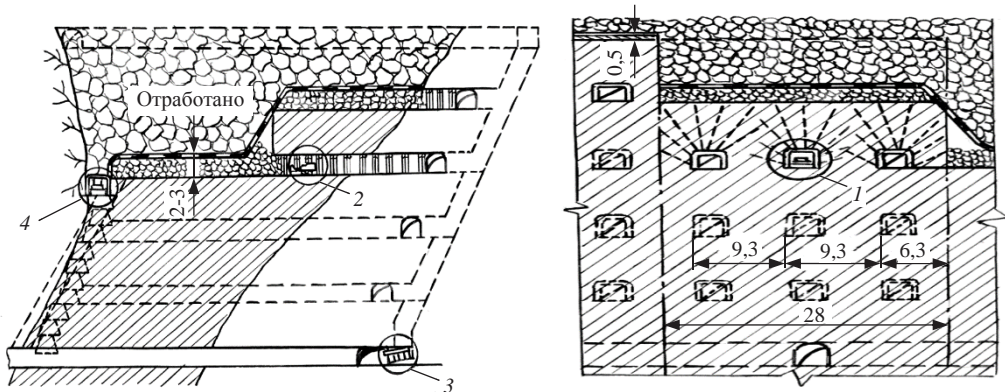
Система подэтажного обрушения с канатно-металлическим перекрытием:
